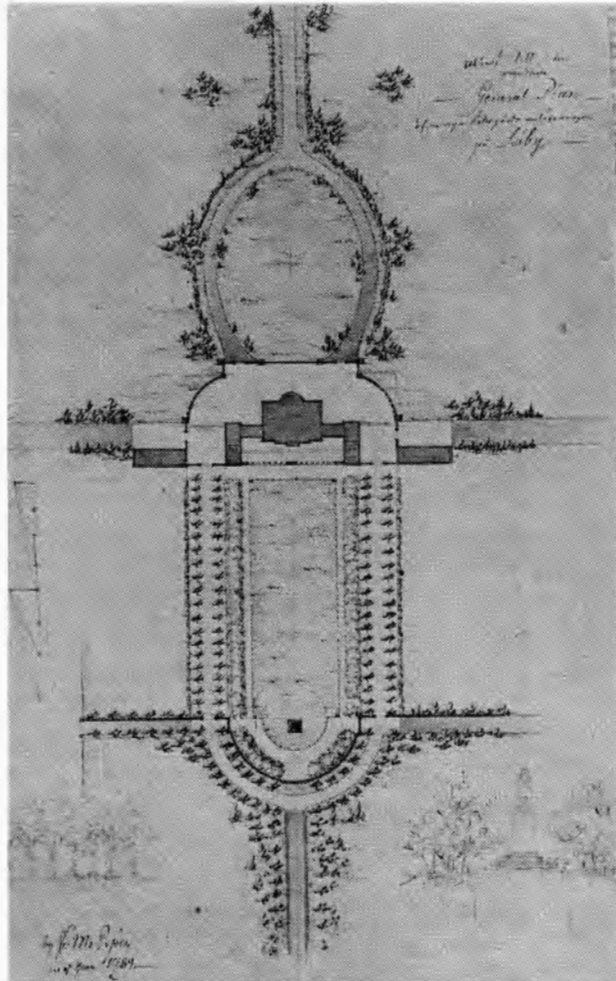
Bjärka-Säby. Plan av F. M. Piper från 1789. — Bjärka-Säby manor. Plan of garden and buildings by F. M. Piper, who studied in England and brought new ideas on landscaping to Sweden.
